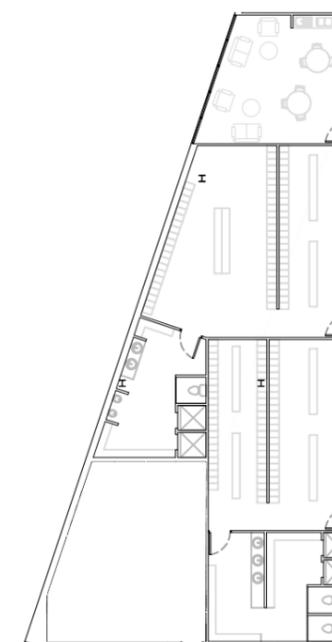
Vestuarios y zona de descanso para conductores de tranvía en la planta baja
